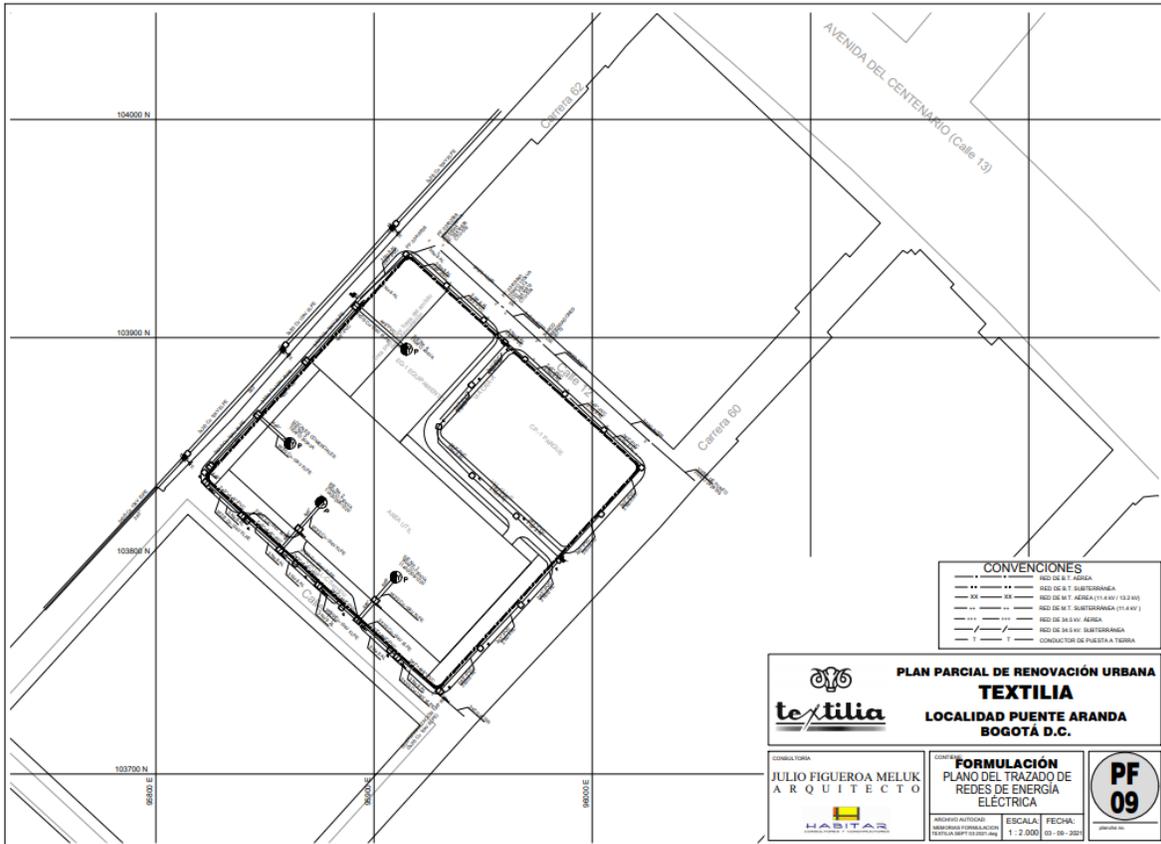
PF 09. Trazado de Redes de Energía Eléctrica
